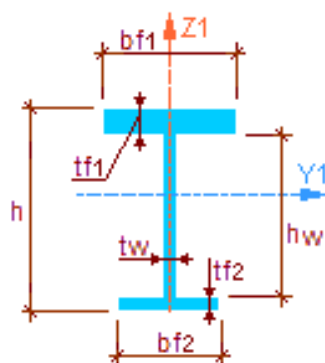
Схема профиля Двутавр сварной несимметричный
